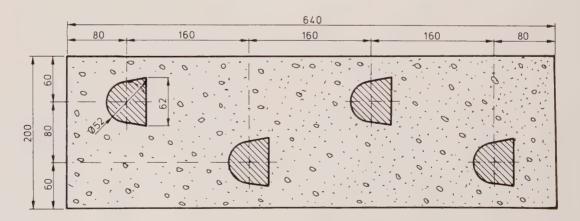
Coupe d'un panneau montrant la forme et l'emplacement des quatre barres en fonte ductile
